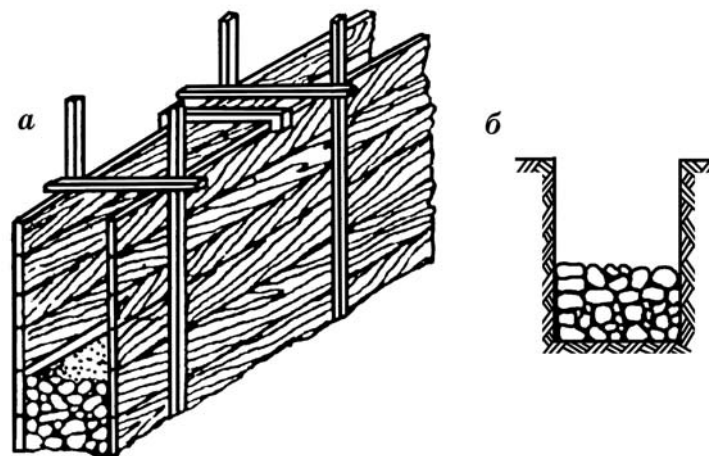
Бутовая кладка: а – в опалубке; б – без опалубки, враспор со стенками траншеи.
